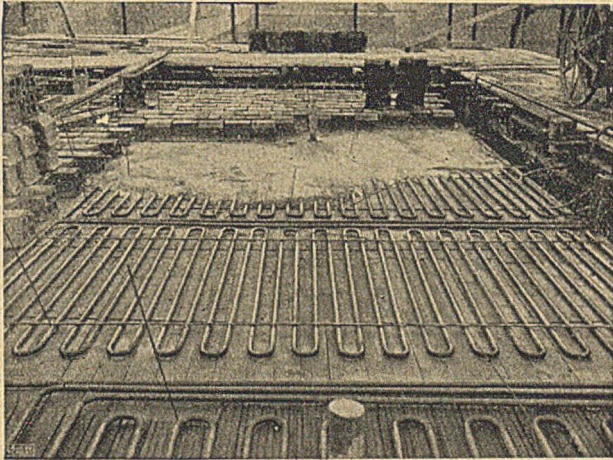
Fertiger Rohreinbau für die Deckenstrahlungsheizung vor dem Einbetonieren.
